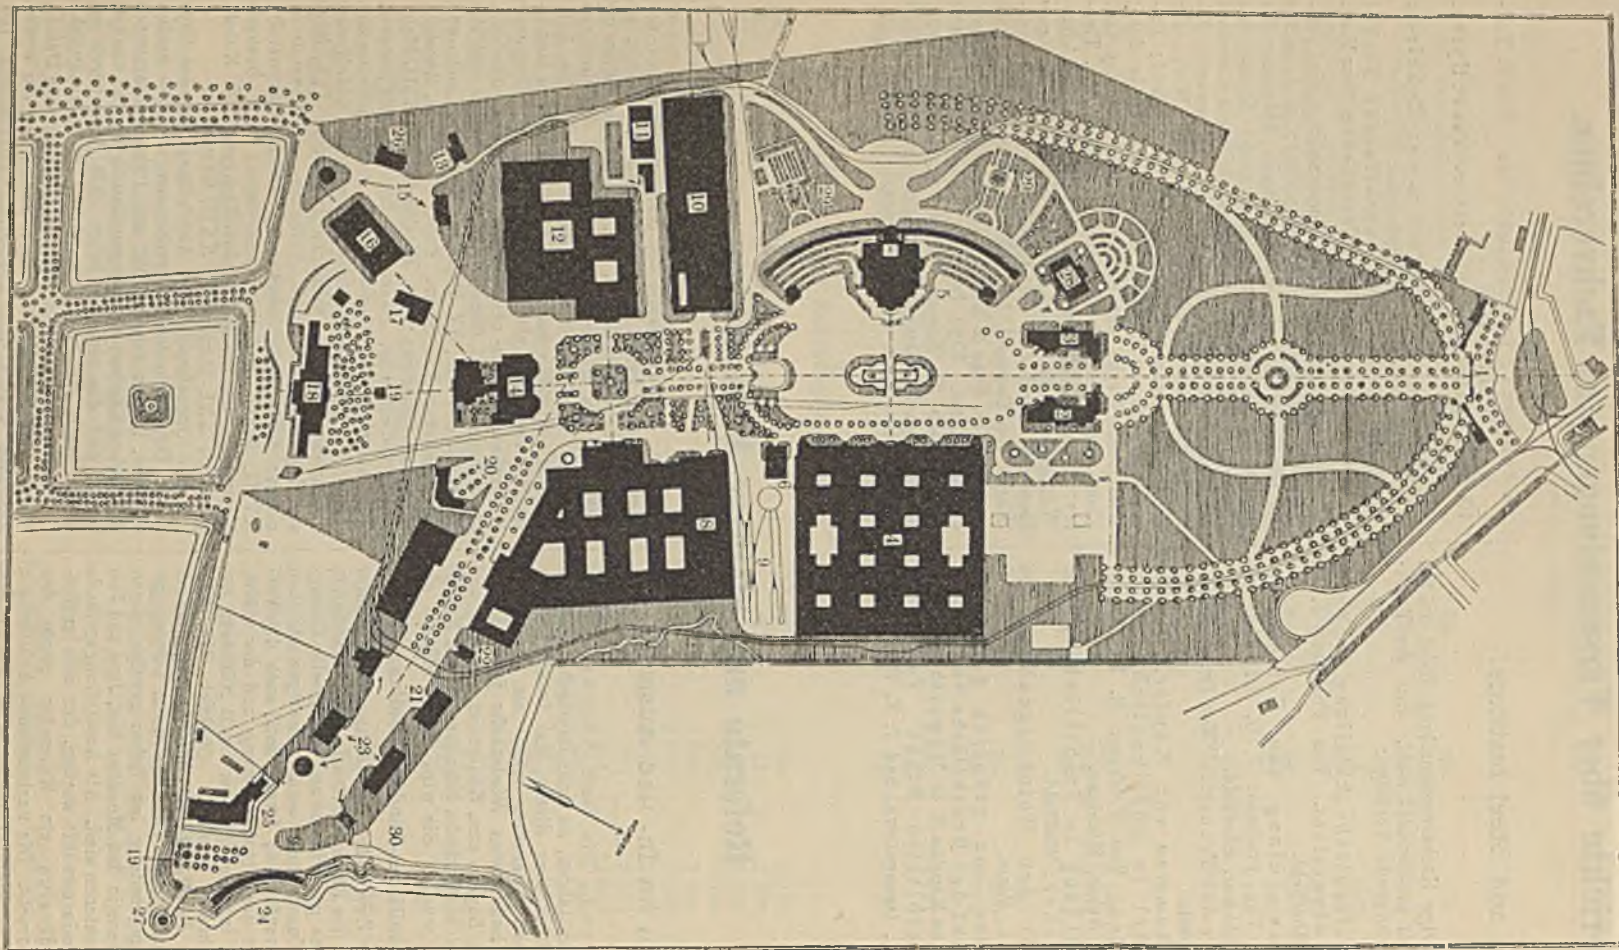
Lageplan der Bayrischen Jubiläums-Landes-Industrie-, Gewerbe- und Kunstausstellung zu Nürnberg.
